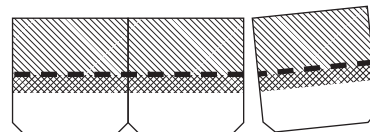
Les bardeaux accessoires Shadow Ridge se détachent facilement de la bande de trois pièces pour former 72 pièces de couronnement individuelles.
